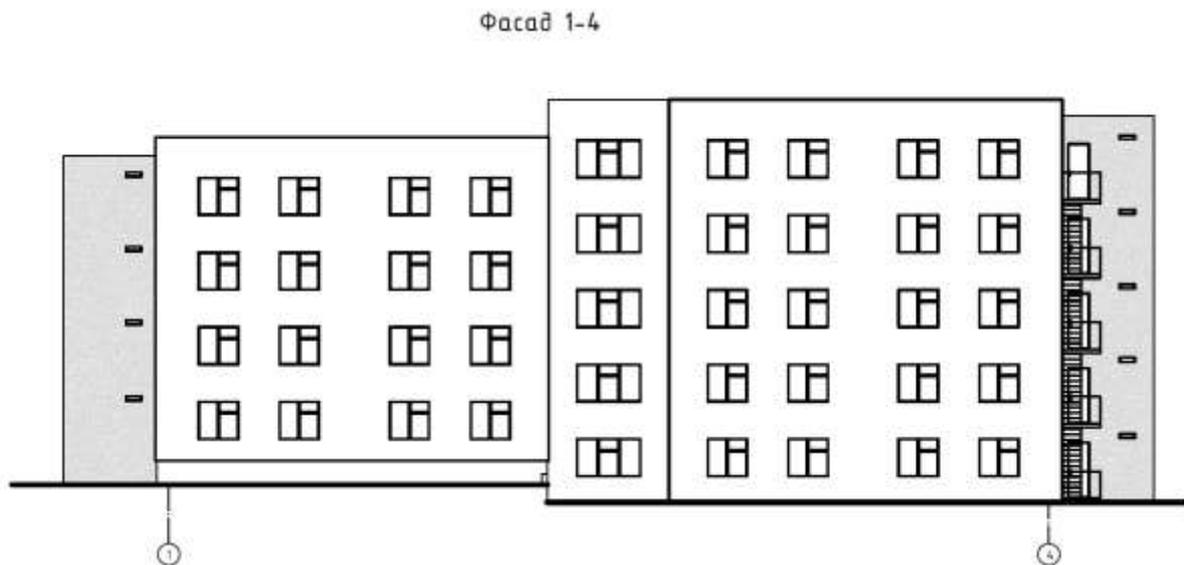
Фасад громадського будинку, проектна пропозиція
